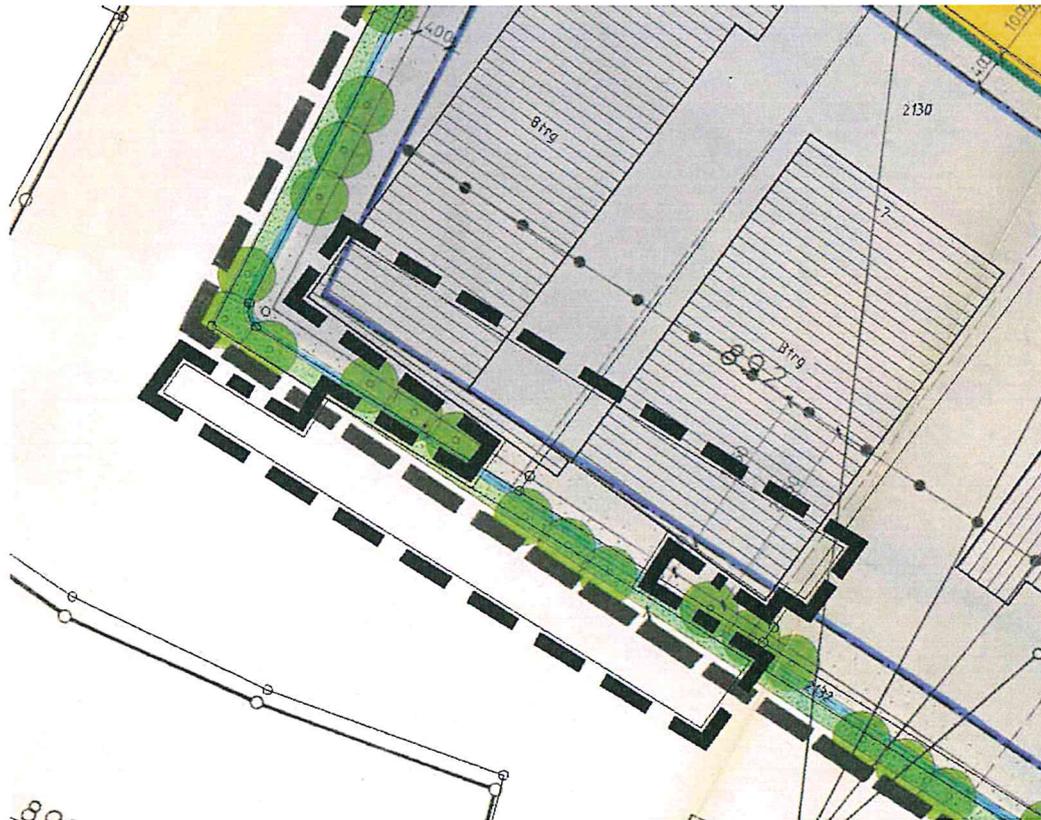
Geltungsbereich des Deckblatts mit überlagertem Bebauungsplan „Im Grün“
